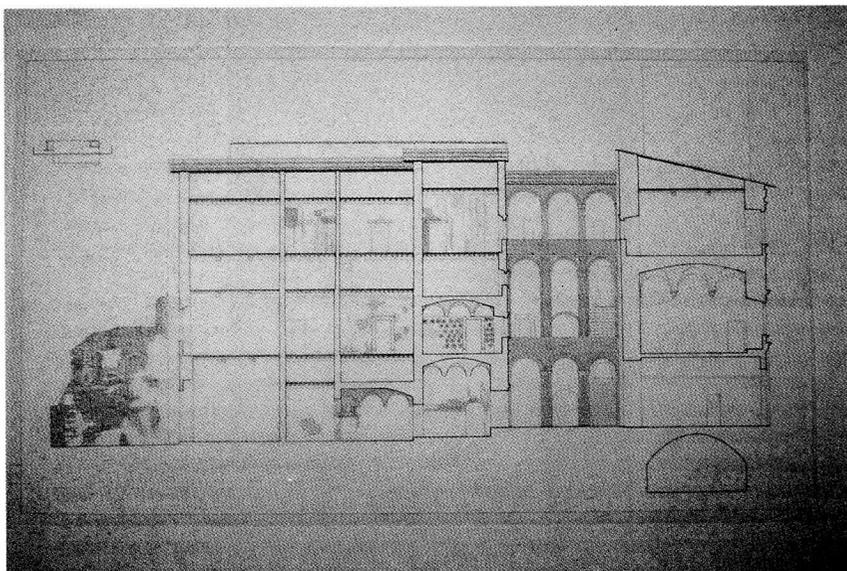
Sezione longitudinale, *ante* ultimi interventi.
